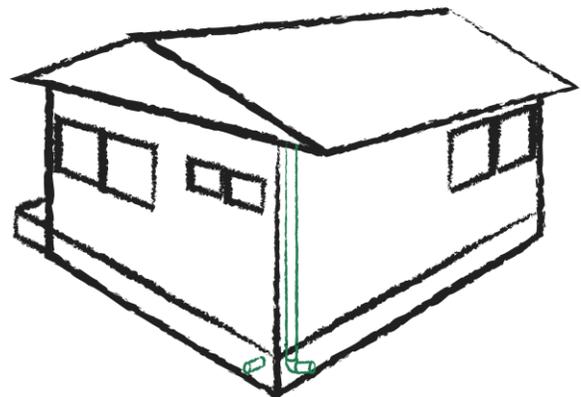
Identificación de bajadas pluviales. Fuente: elaboración propia.
